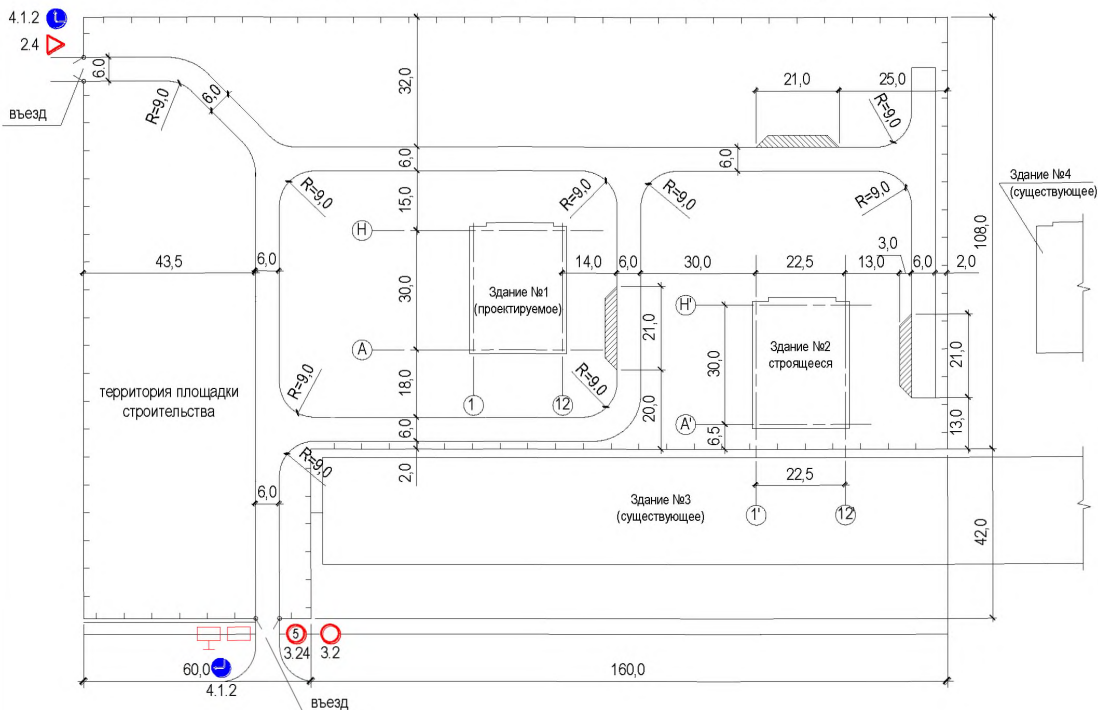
Стройгенплан с нанесёнными стоянками автотранспорта под разгрузку/погрузку.
